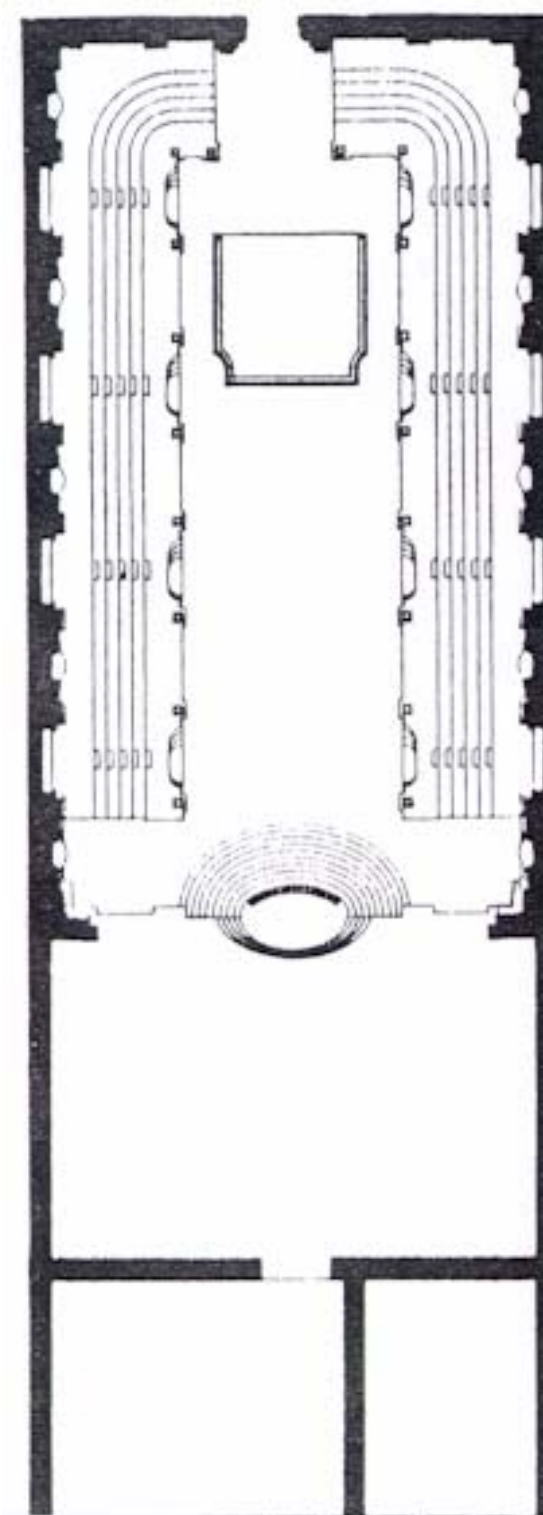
Planta del teatro Mediceo. Reconstrucción de Cesare Lisi.
